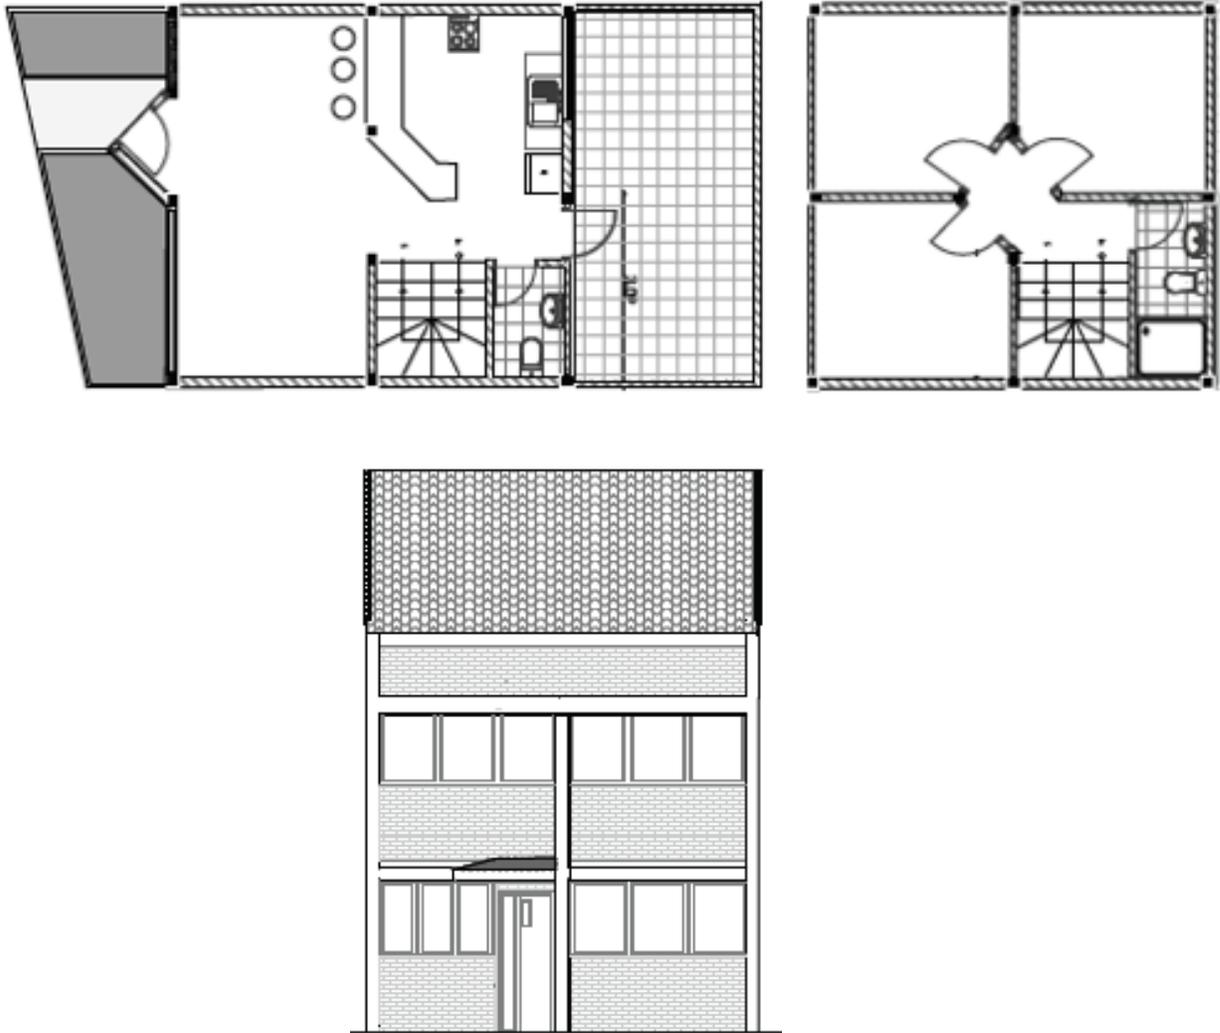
Planta arquitectónica y fachada vivienda 2 plantas tipo 1 en urbanización "Los Nogales".
